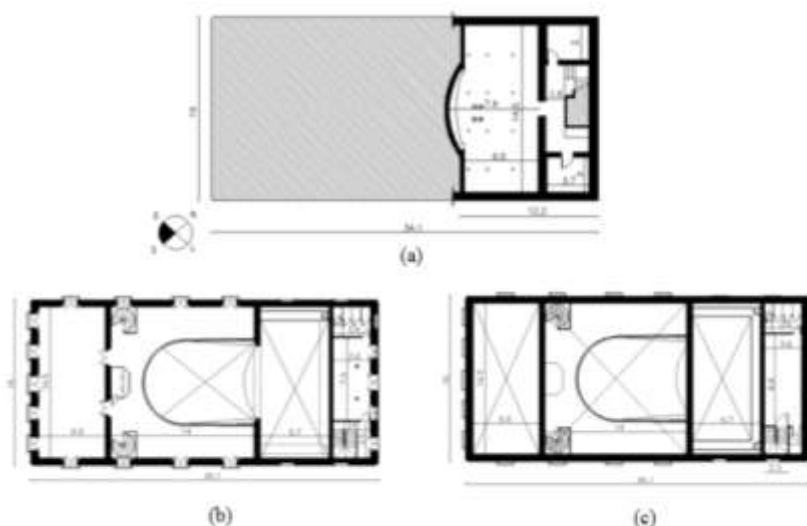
Planta baixa do pavimento subterrâneo em (a), do 1º pavimento acima do solo em (b) e do 2º pavimento acima do solo do Teatro São João em (c).
